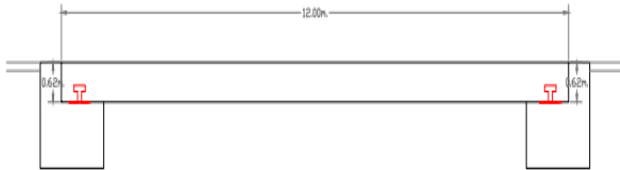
Esquema básico de fijación de los contenedores a estribos prefabricados de hormigón. El sistema de anclaje está conformado por piñas apernadas al estribo, el cual incorpora en su diseño una placa metálica empotrada y una lámina de neopreno destinada a mejorar el comportamiento sísmico. Fuente: *Elaboración propia.
